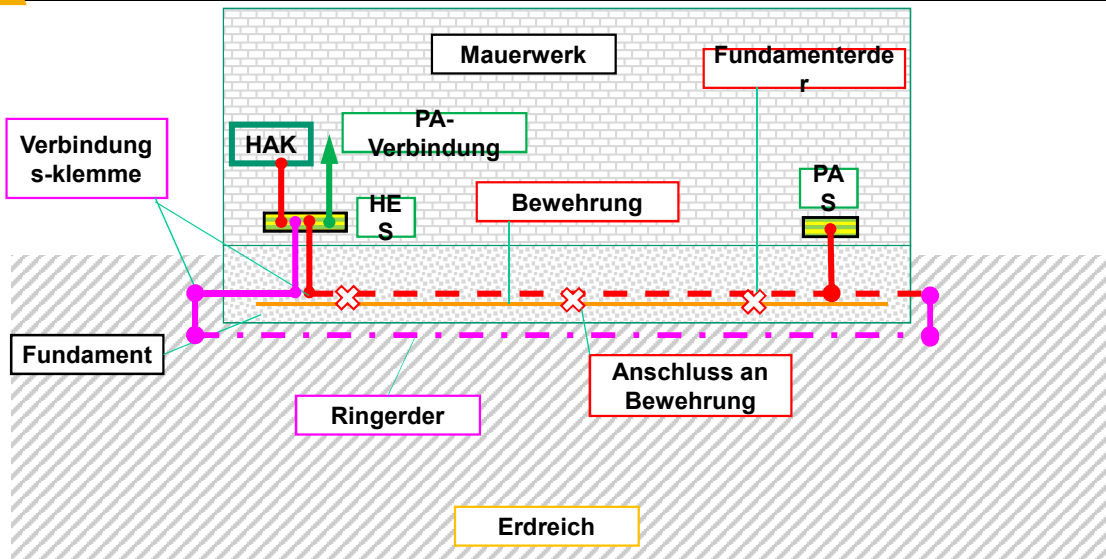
Prinzipdarstellung für eine Erdungsanlage mit Ringerder bei einem Fundament mit erhöhtem Erdübergangswiderstand - Schnitt
